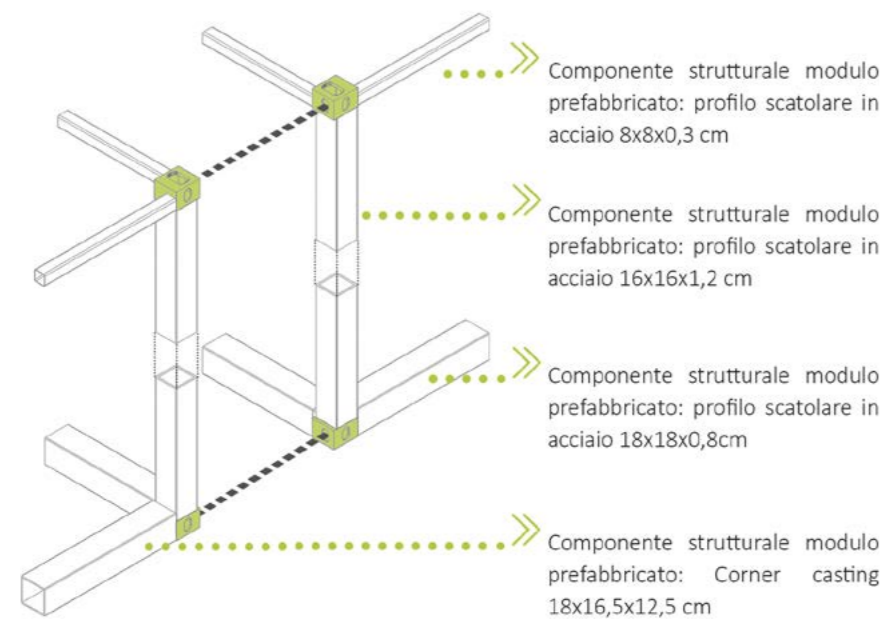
Dettaglio fissaggio orizzontale tra moduli in acciaio.
